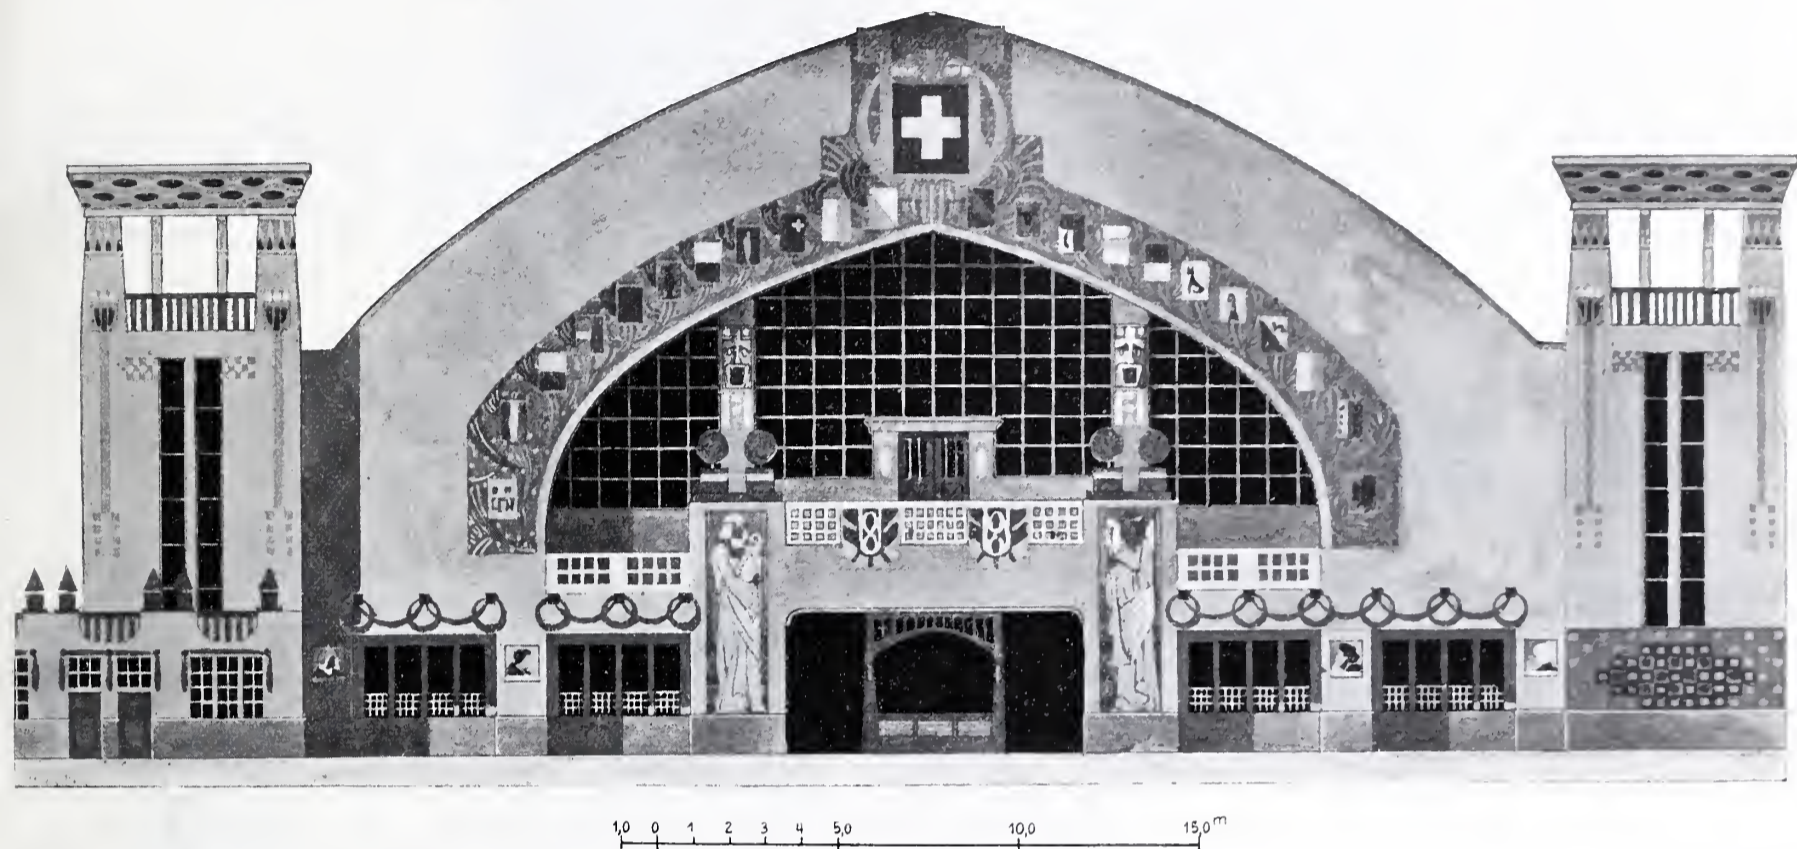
Ansicht der Hauptfassade der Festhalle gegen den Bellevueplatz. — Masstab 1 : 250.
